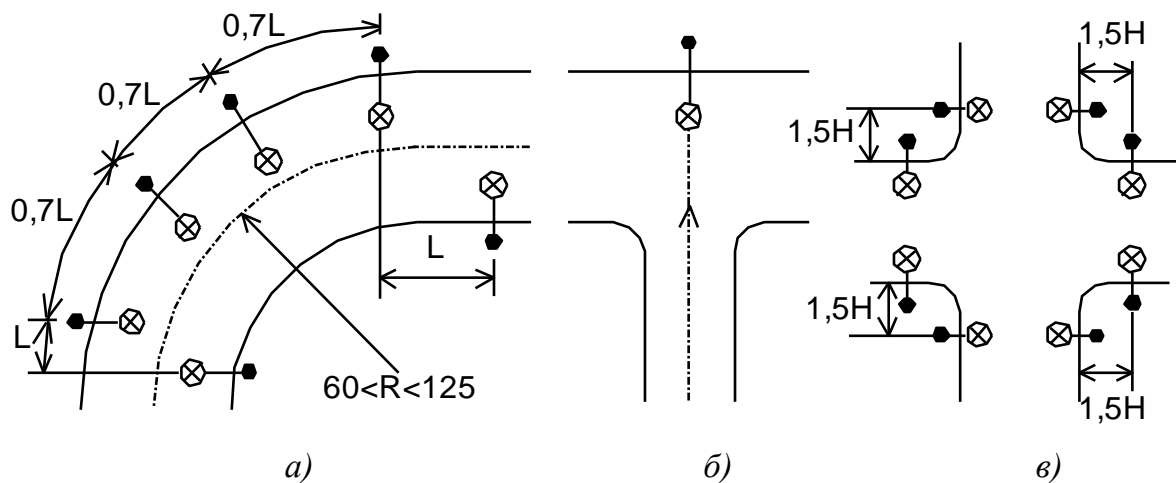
Схема расположения светильников: а – на закруглении; б – на примыкании; в – на пересечении; H – высота установки светильников
